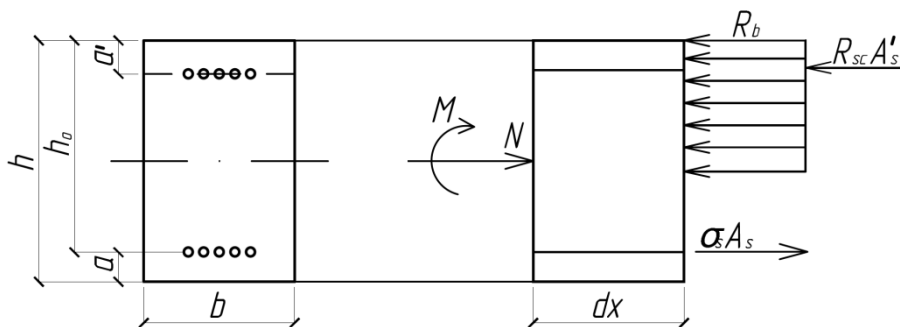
К расчету на прочность сжатого верхнего пояса подстропильной рамы
